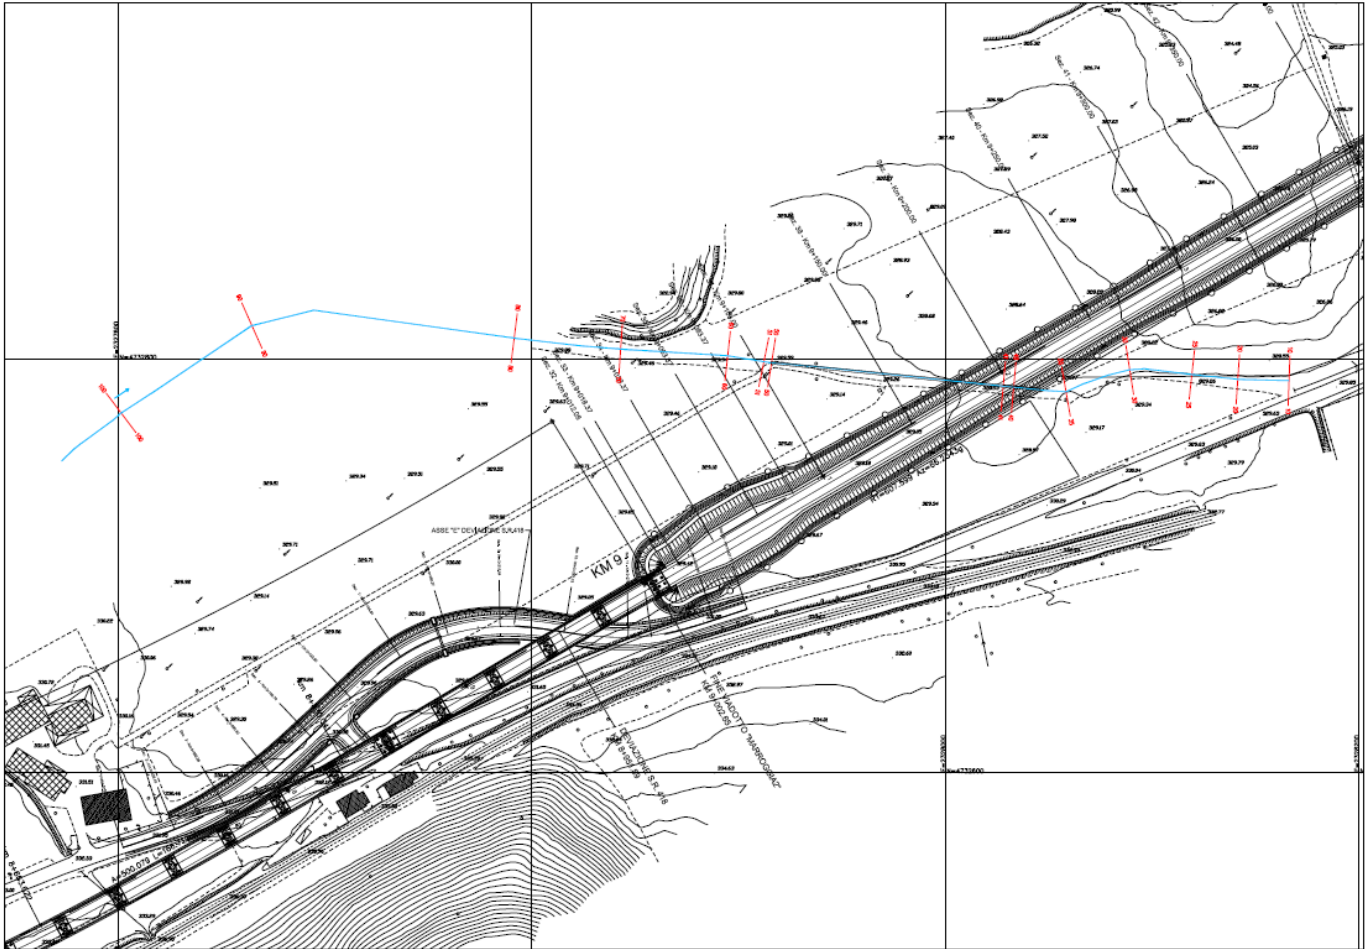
Planimetria dell'intervento e sezioni trasversali d'alveo.
